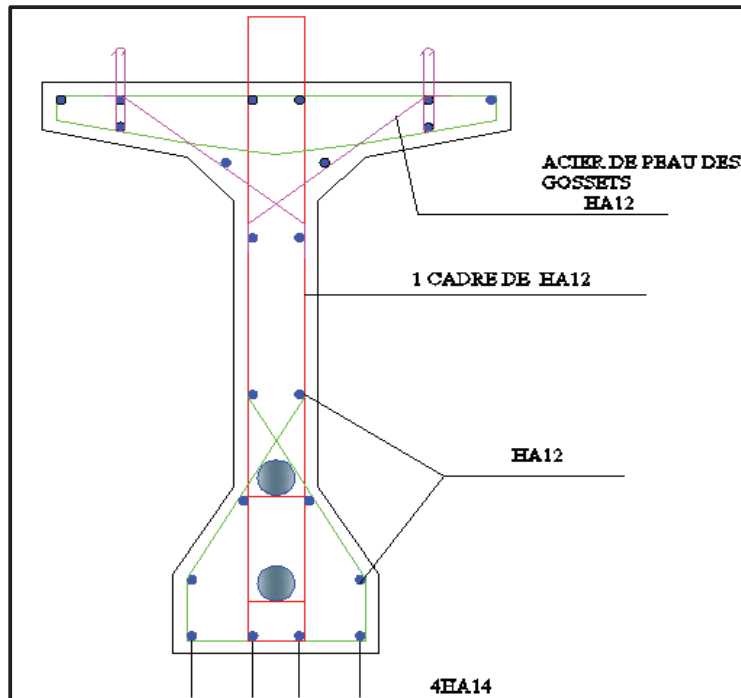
Ferrailage de la poutre à mi-travée. [5]
